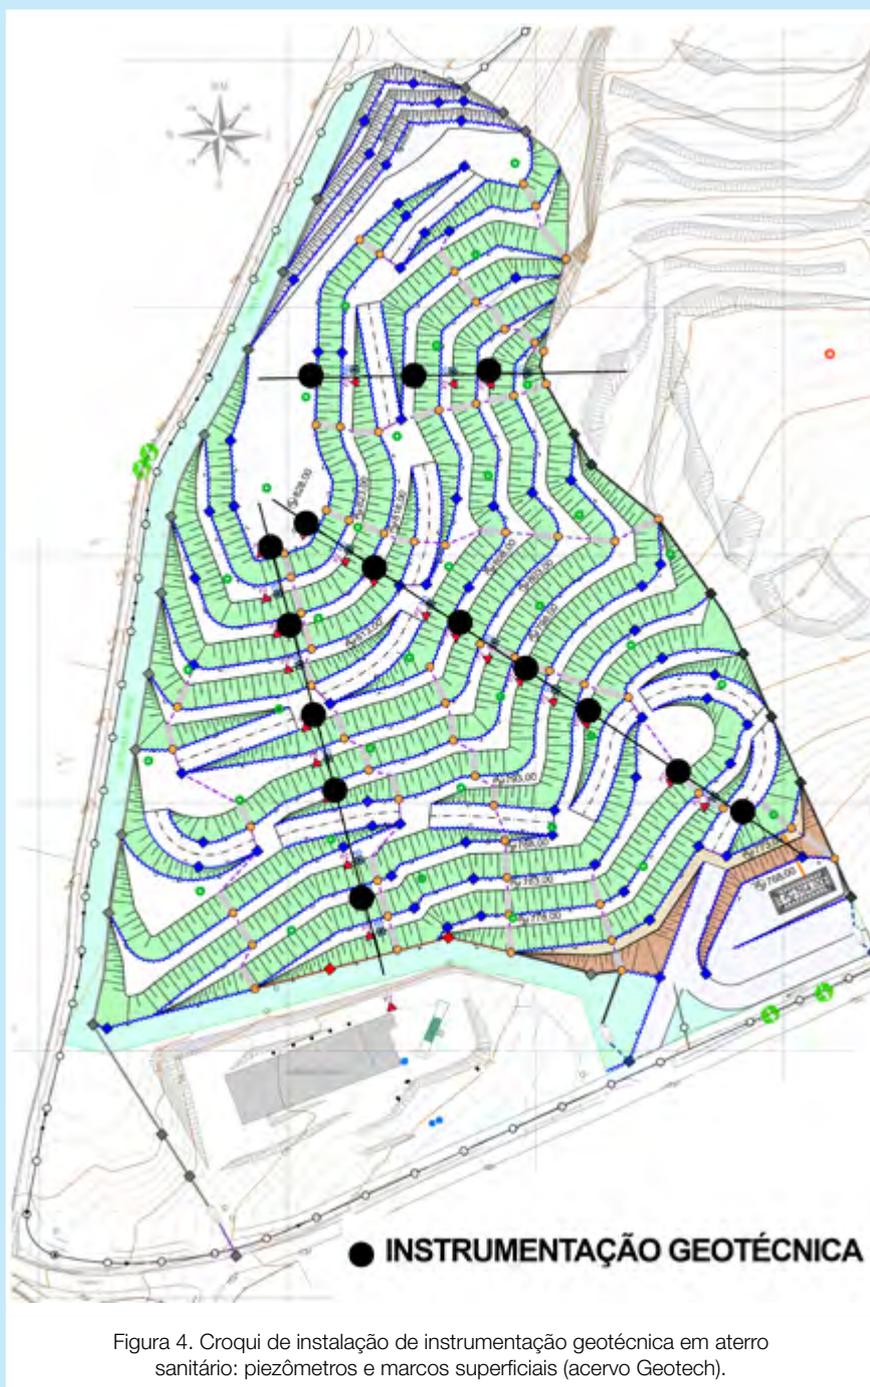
Croqui de instalação de instrumentação geotécnica em aterro sanitário: piezômetros e marcos superficiais (acervo Geotech).
